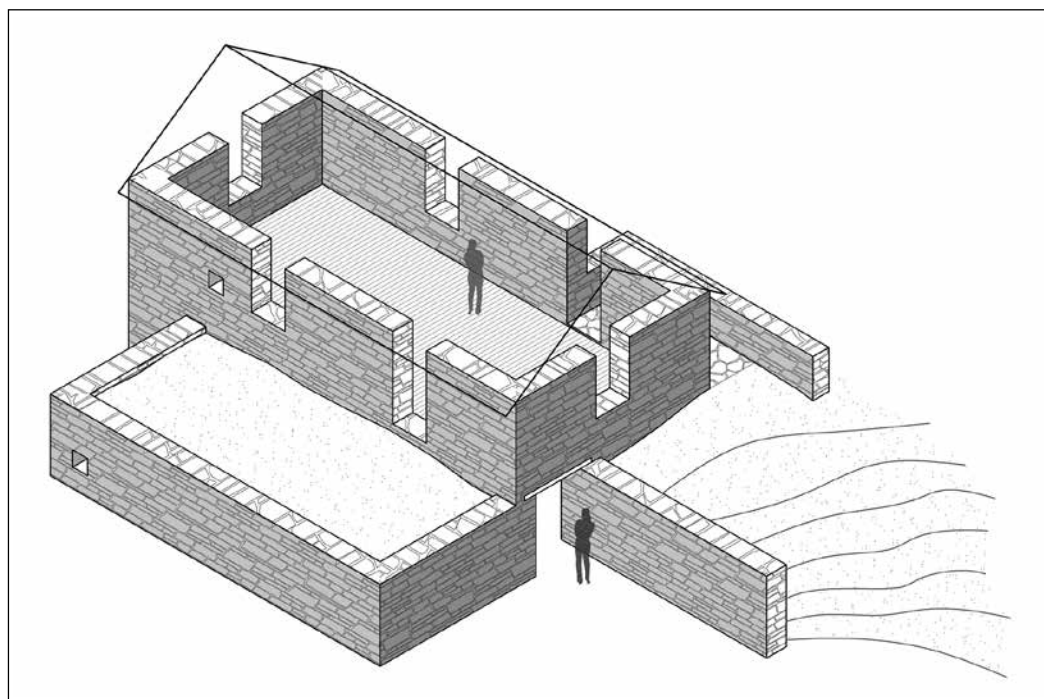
Reconstrucción de la Estructura II, una tipología germana de construcción. La Figura 2 es una foto de la puerta inferior de esta estructura.
